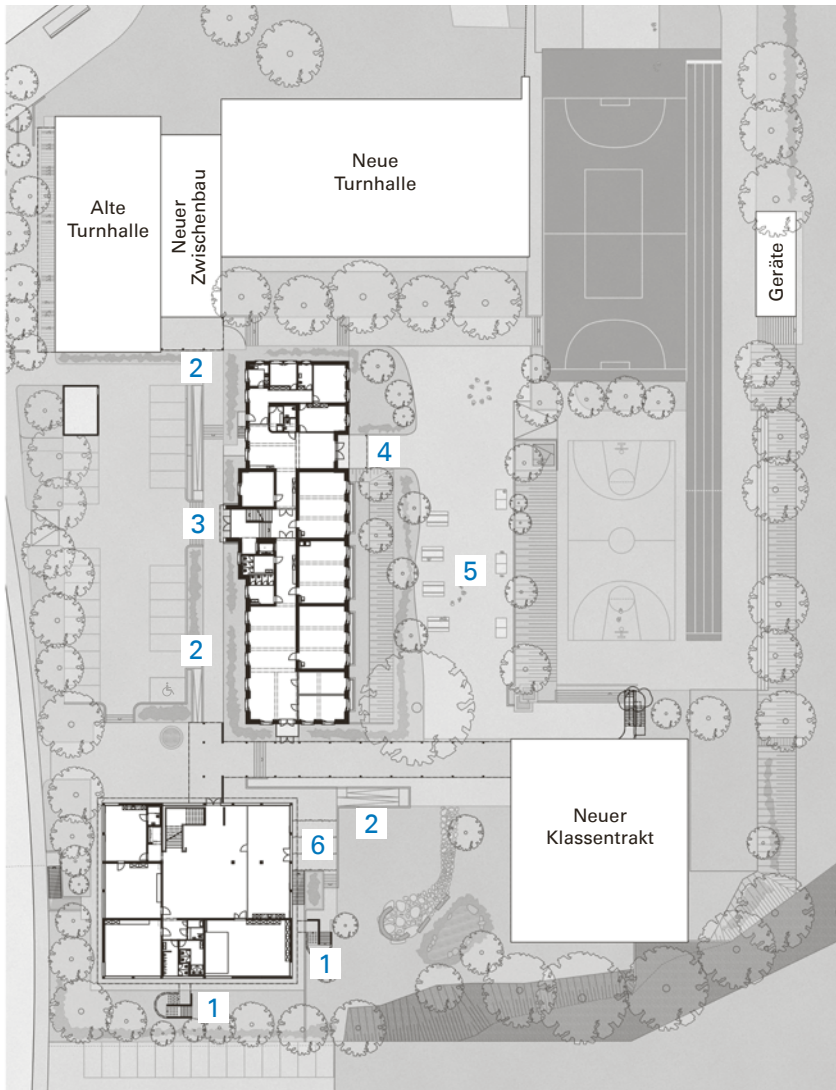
Skizze der sanierten Gebäude (Grundriss) und des Aussenraums;
